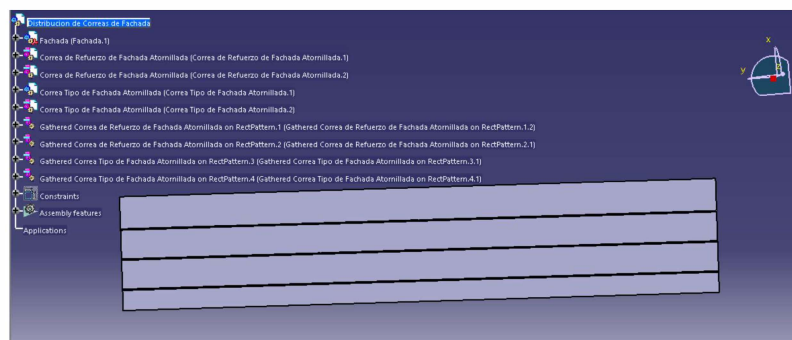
Distribución de las correas de fachada junto con la fachada de posicionamiento
